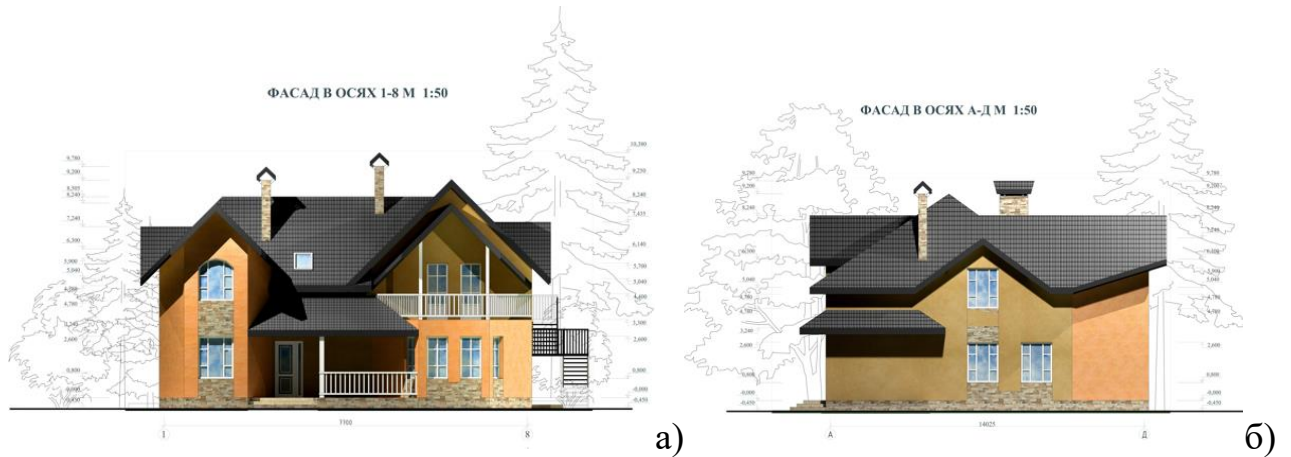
а) Фасад в осях 1-8; б) Фасад в осях А-Д
